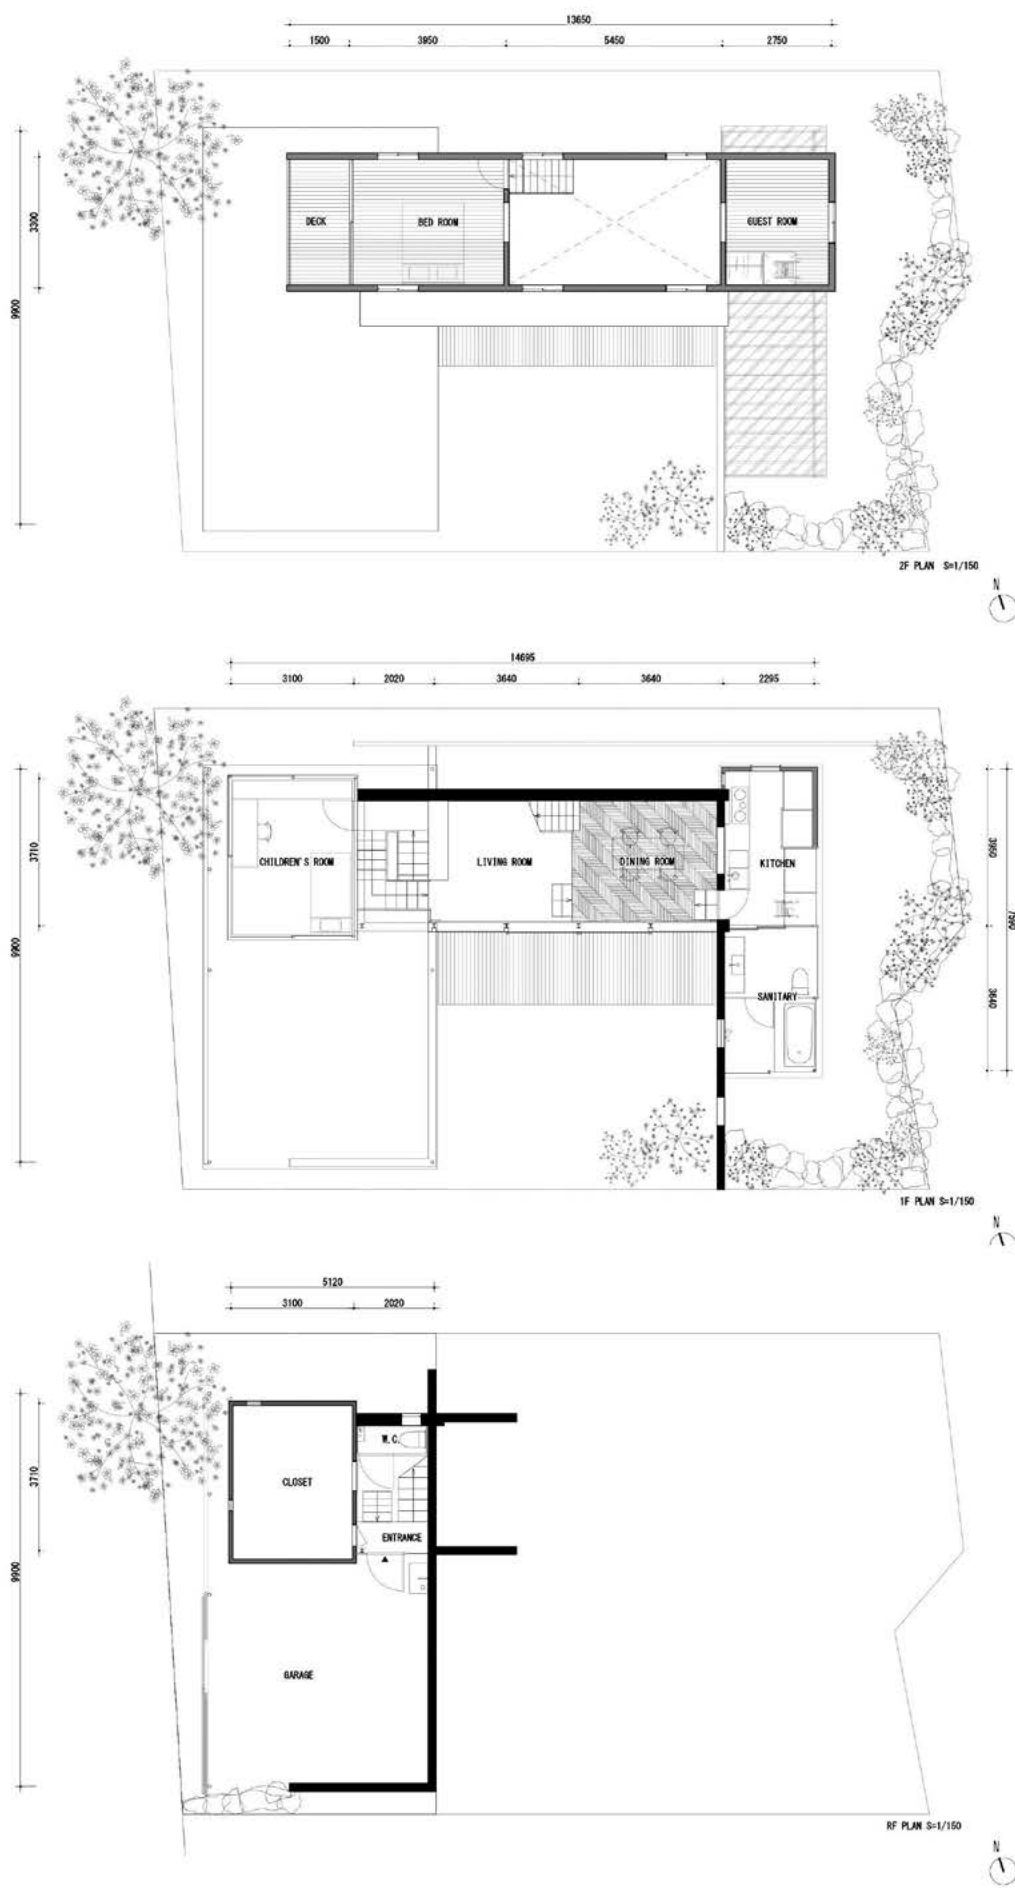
Casa a Ishikiri - Pianta del piano terra, del primo piano e del secondo piano
